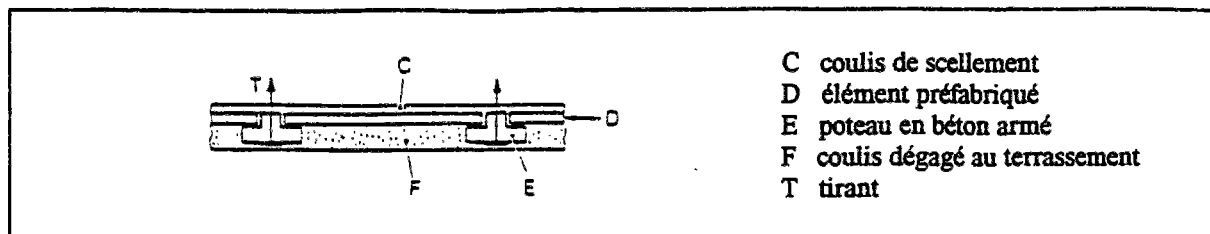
Exemple de paroi préfabriquée de type poteaux + dalles : vue en plan (Balay, 1988).
